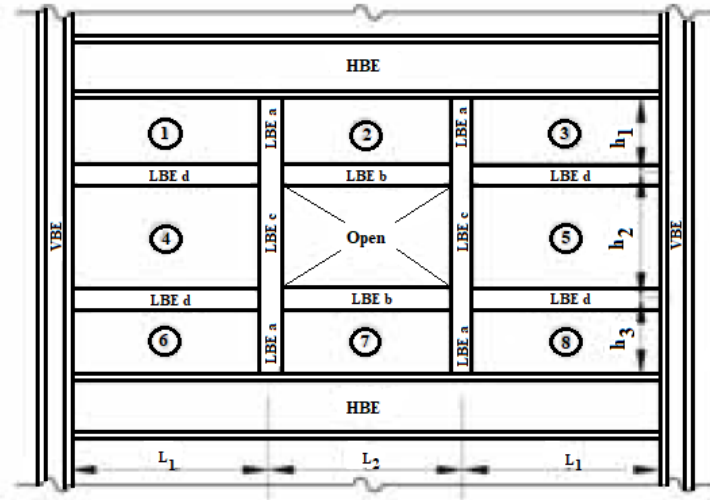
Ejemplo de aperturas en el alma. (Fuente: Extracto de la Fig. 6-3 f) de DG 20 Steel Plate Shear Wall (2006))
